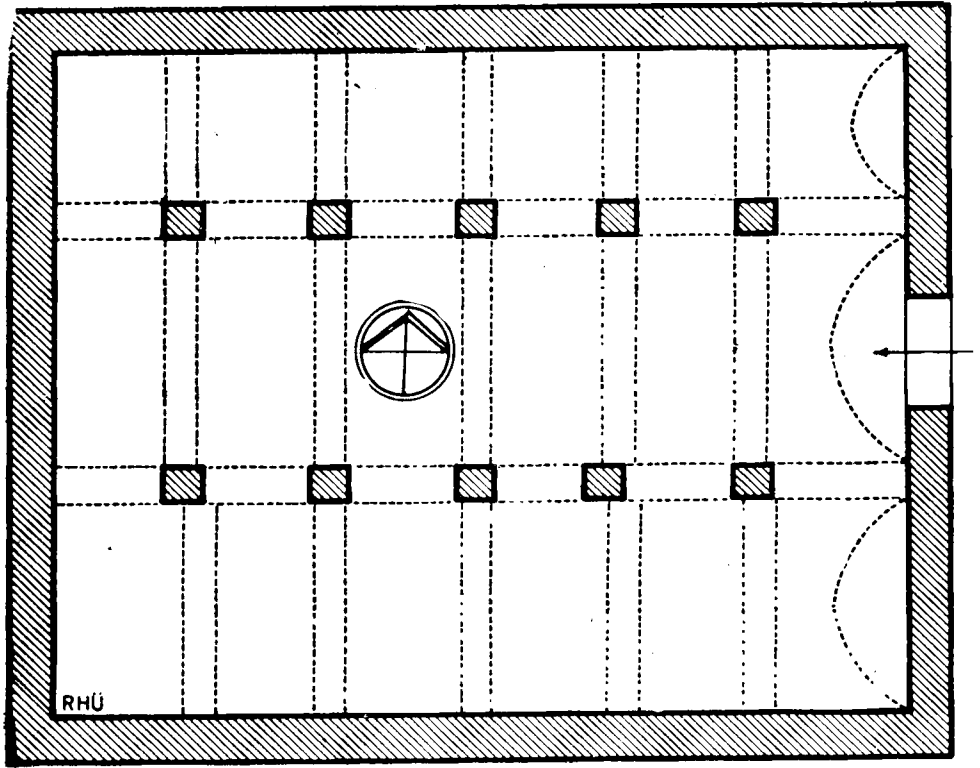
Kantarmış Hamamı (Arapkır-Divriği). Plan.
